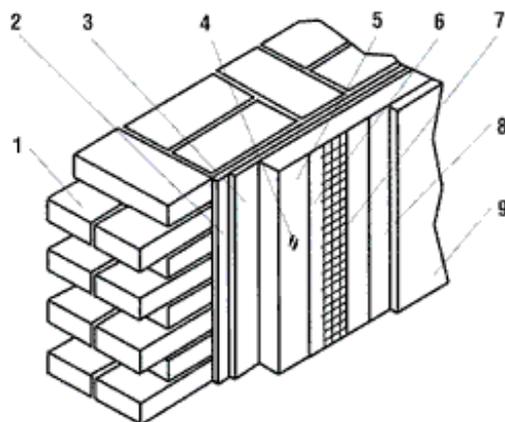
Штукатурная система утепления фасадов: 1 - стена; 2 - наружная отделка; 3 - клеящий состав; 4 - дюбель; 5 - утеплитель из минеральной ваты или пенополистирола; 6 - клеевой армирующий состав; 7 - армирующая сетка; 8 - грунтовка; 9 - отделочный слой
